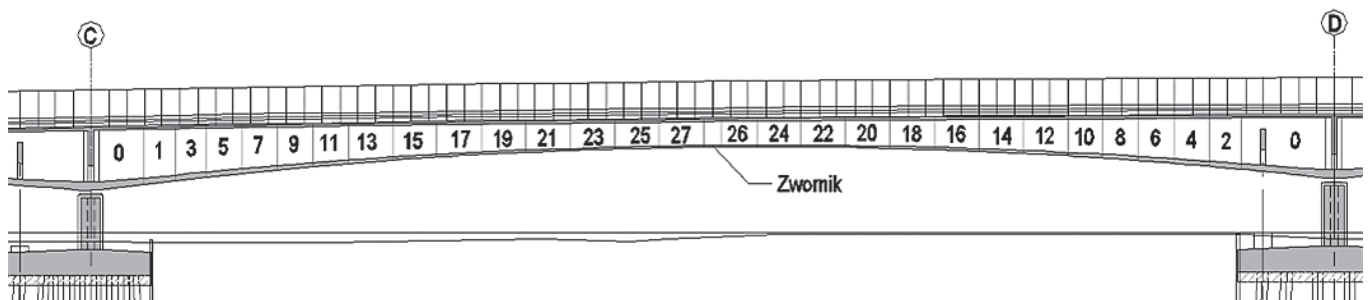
Faza III: betonowanie, dojrzewanie i pielęgnacja segmentu
